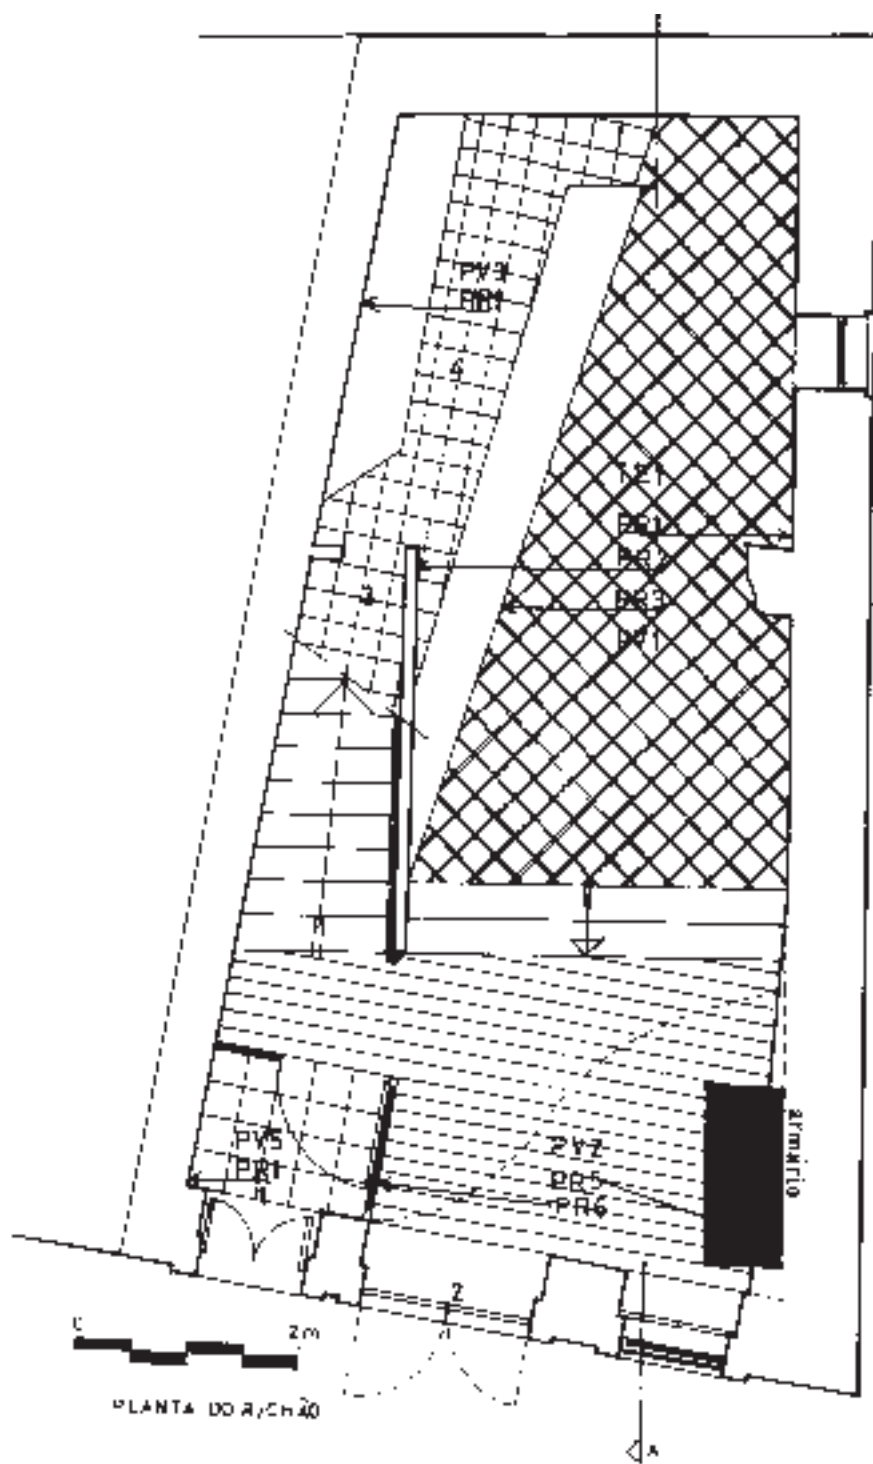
Planta actual de localização do armário, no piso térreo de entrada.
